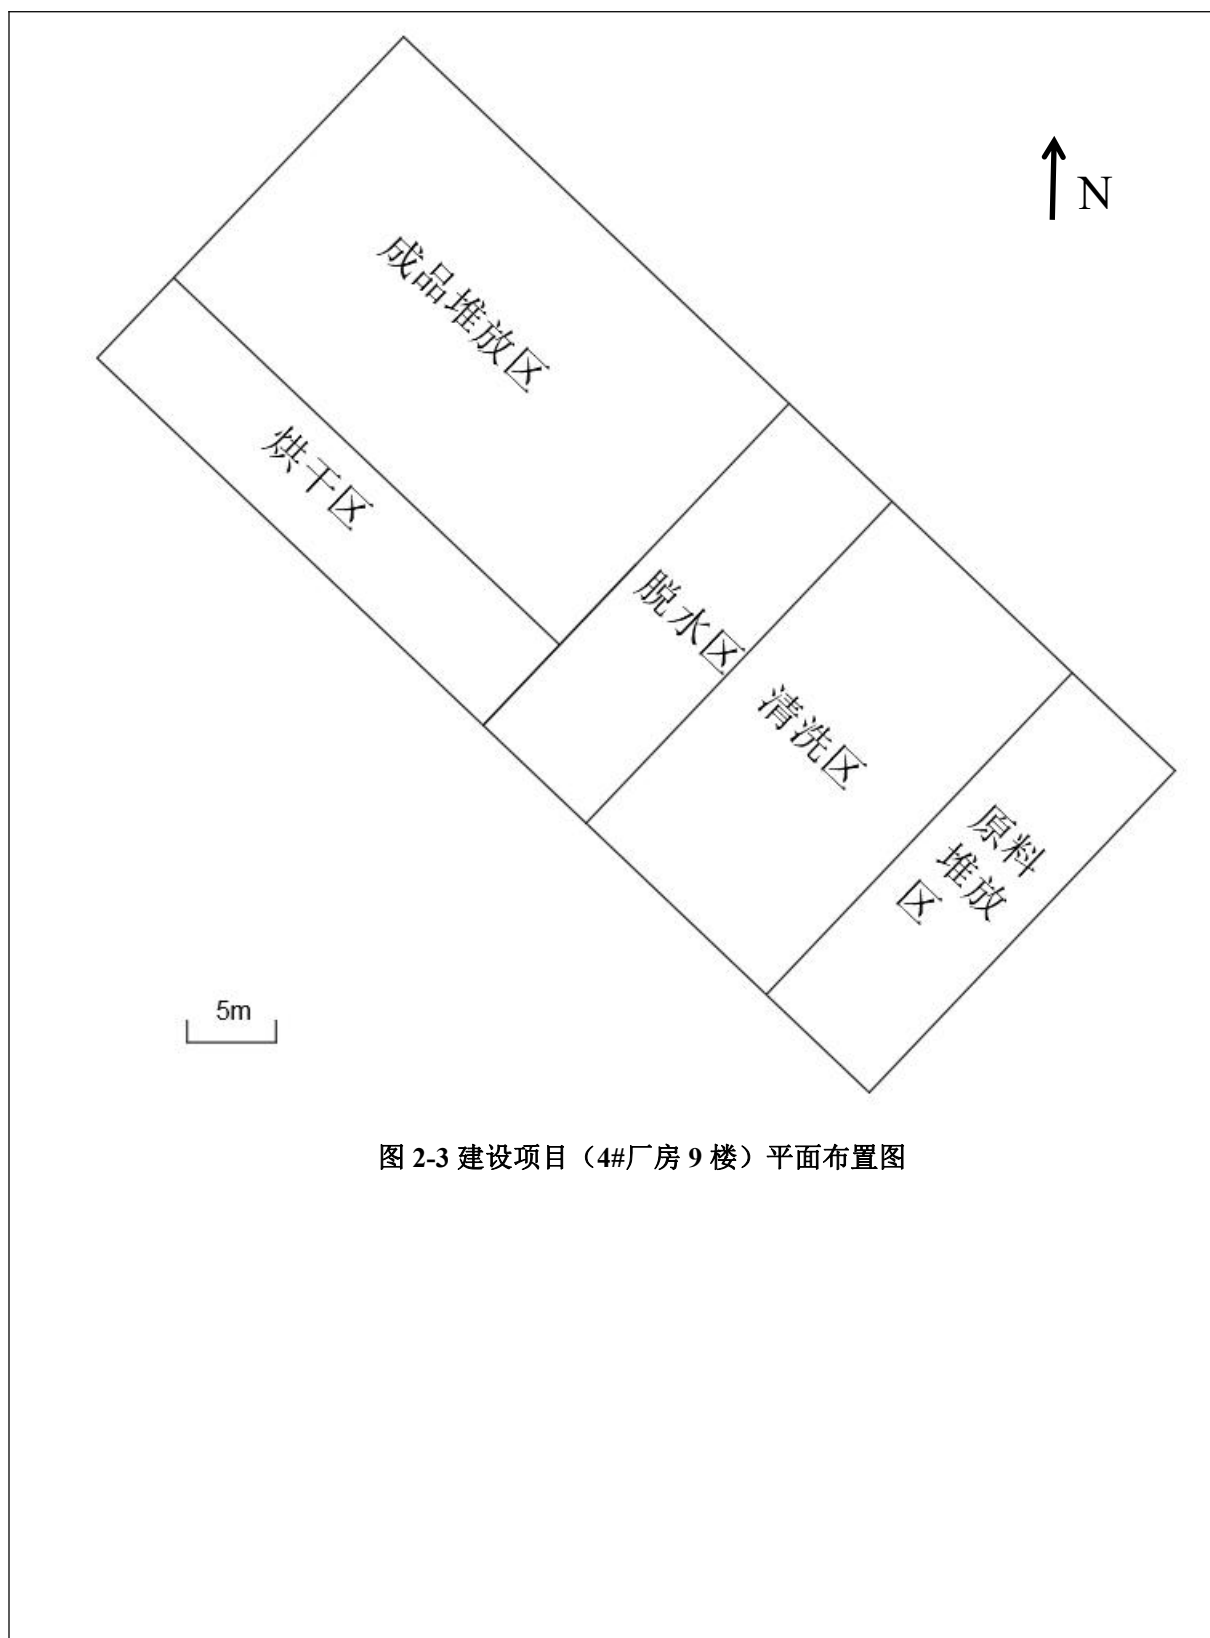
建设项目（4#厂房 9 楼）平面布置图
